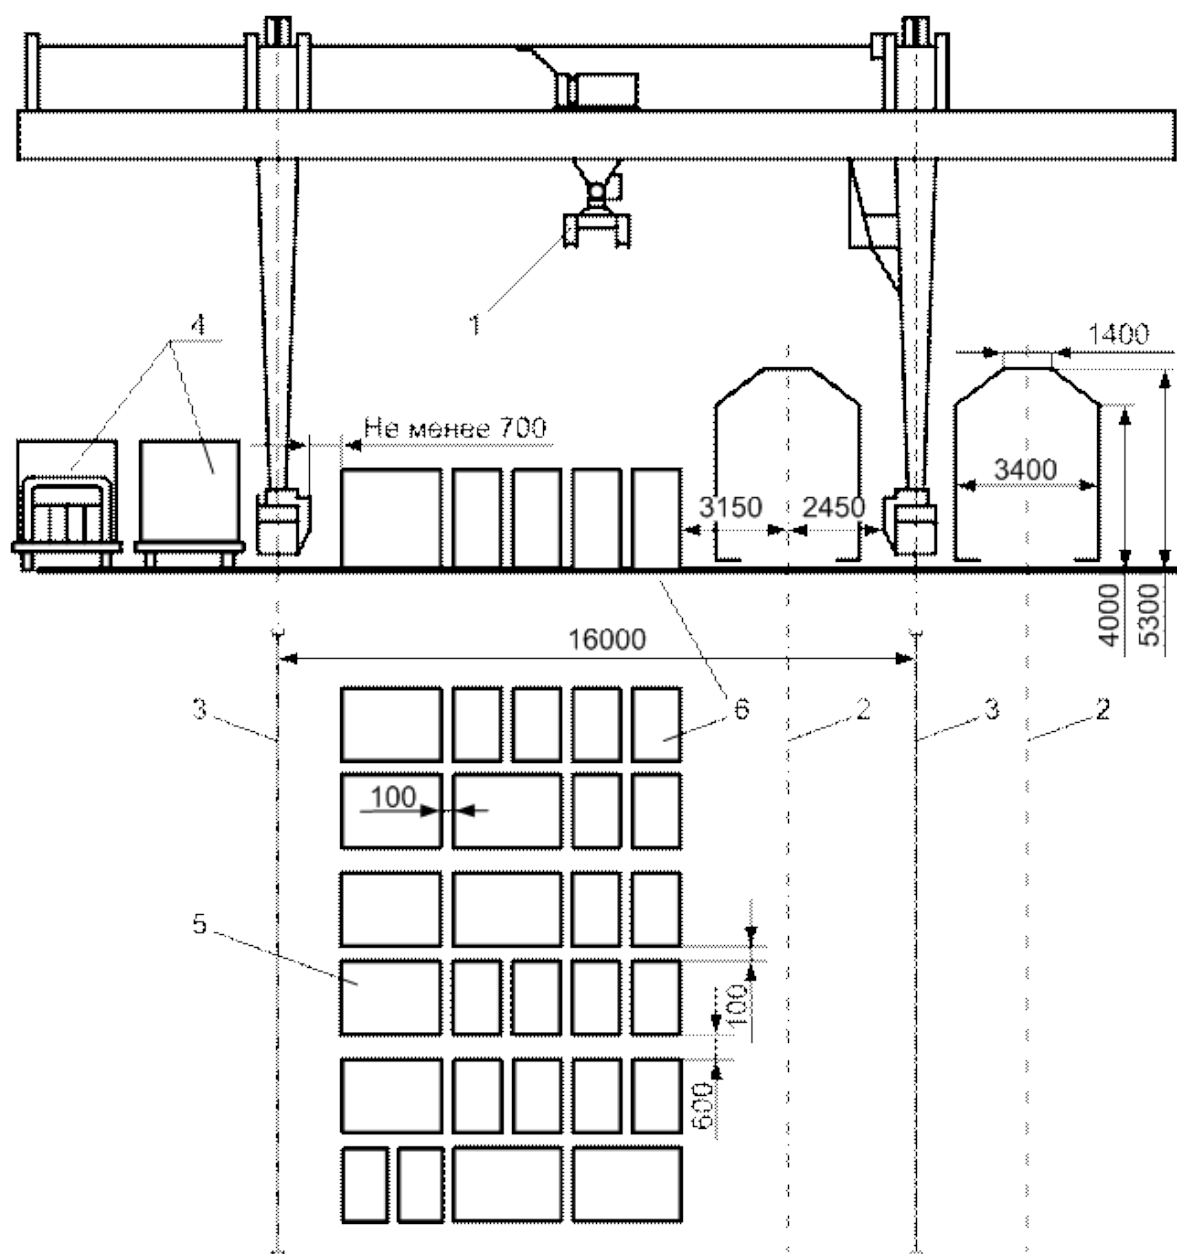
Схема комплексной механизации и размещения среднетоннажных контейнеров на площадке с двумя погрузочно-разгрузочными путями, обслуживаемыми козловым краном пролетом 16 м: 1 – грузовая тележка крана; 2 – оси железнодорожных путей; 3 – подкрановые пути; 4 – автомобили для завоза–вывоза контейнеров; 5 – контейнер массой брутто 5 т; 6 – контейнер массой брутто 3 т.
